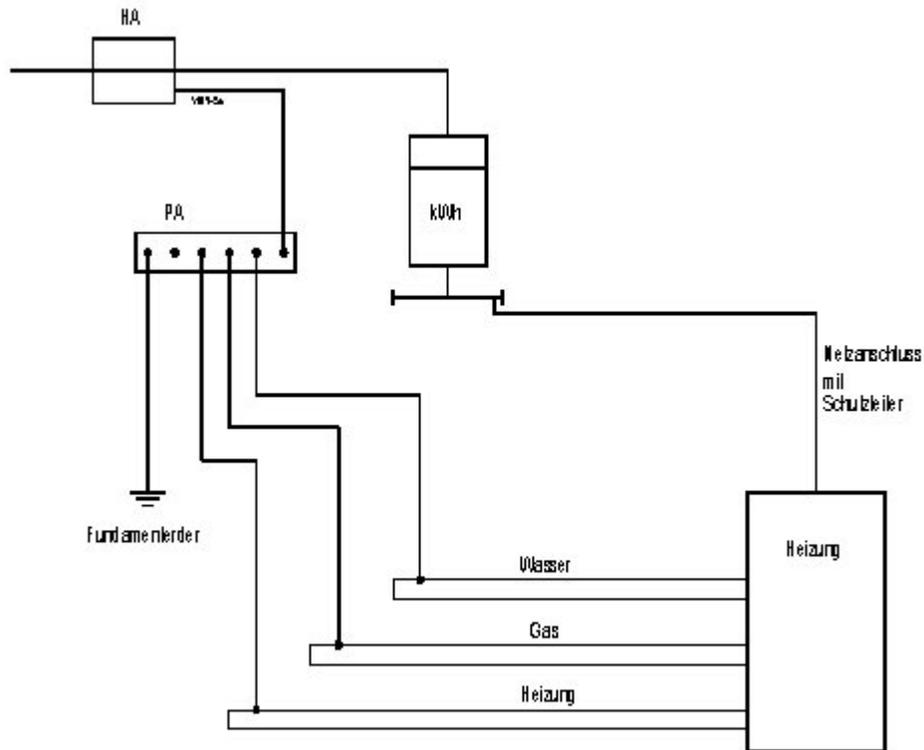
Messung an einer Potentialausgleichsleitung mit der Erdungsprüfzange in einem TN-System
